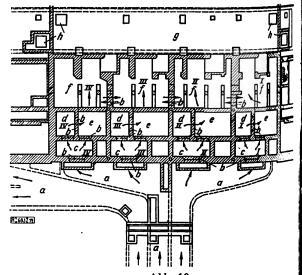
Kellergeschoß des Turbinenhausvorbaues mit Wasserführung, Schiebern, Rechen und Sieben
